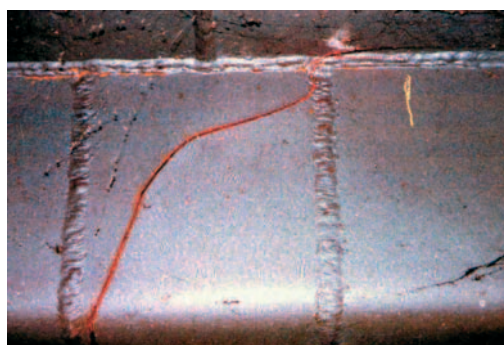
Fissure de fatigue dans un auget de dalle orthotrope (Crédit LRPC)
